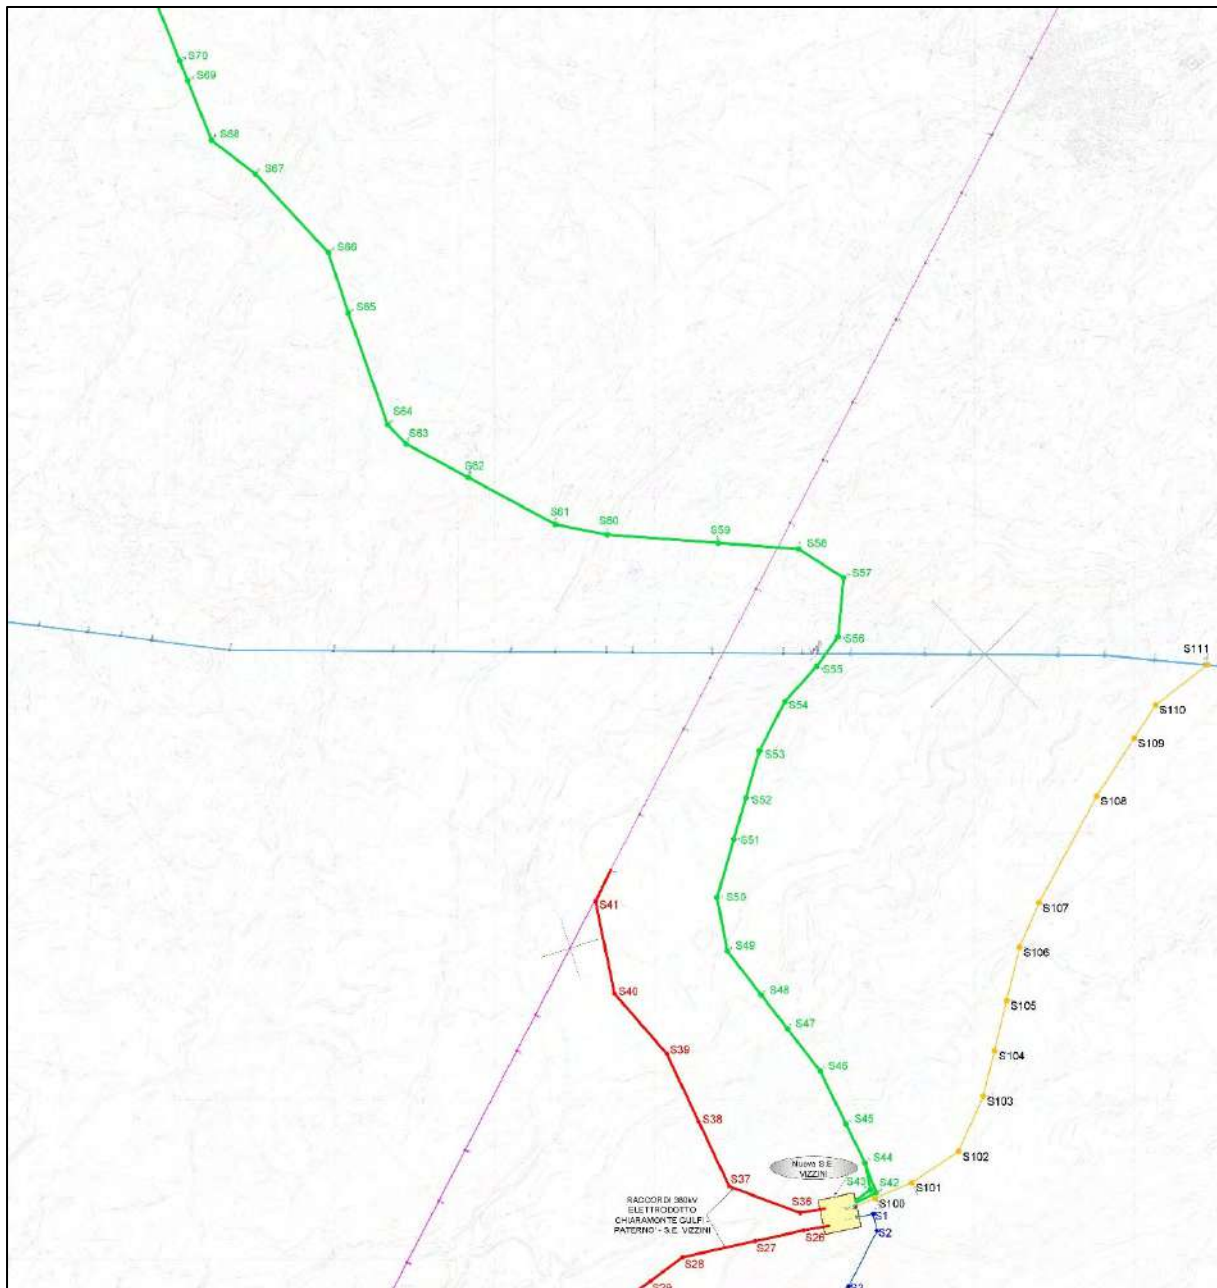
Planimetria con ubicazione prelievi linee foglio 03_2
